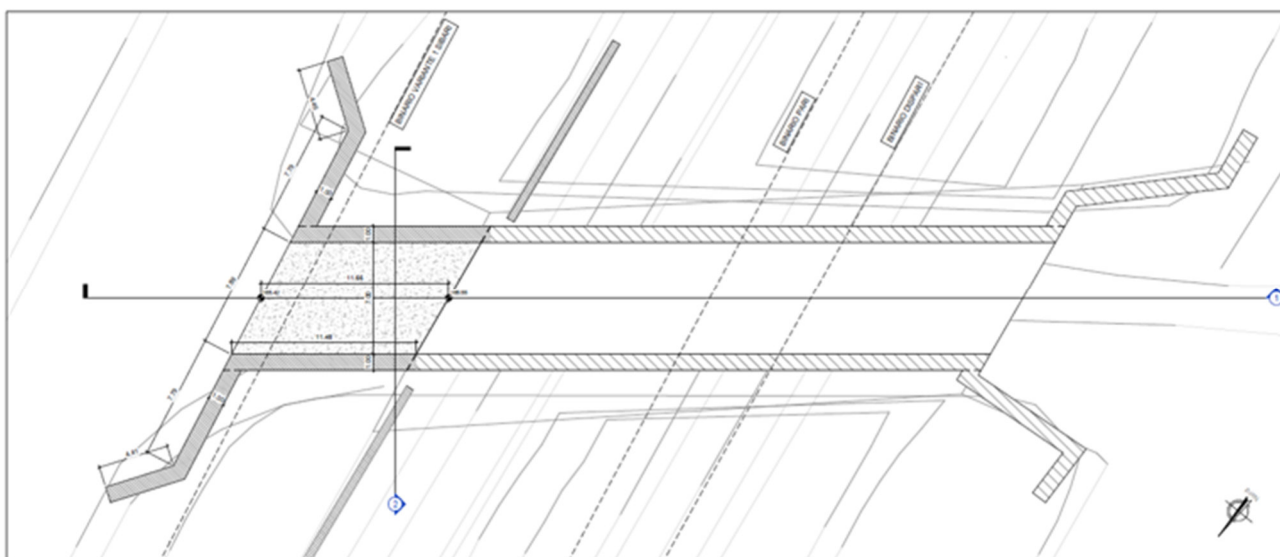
Planimetria d'inquadramento sottovia SL01
